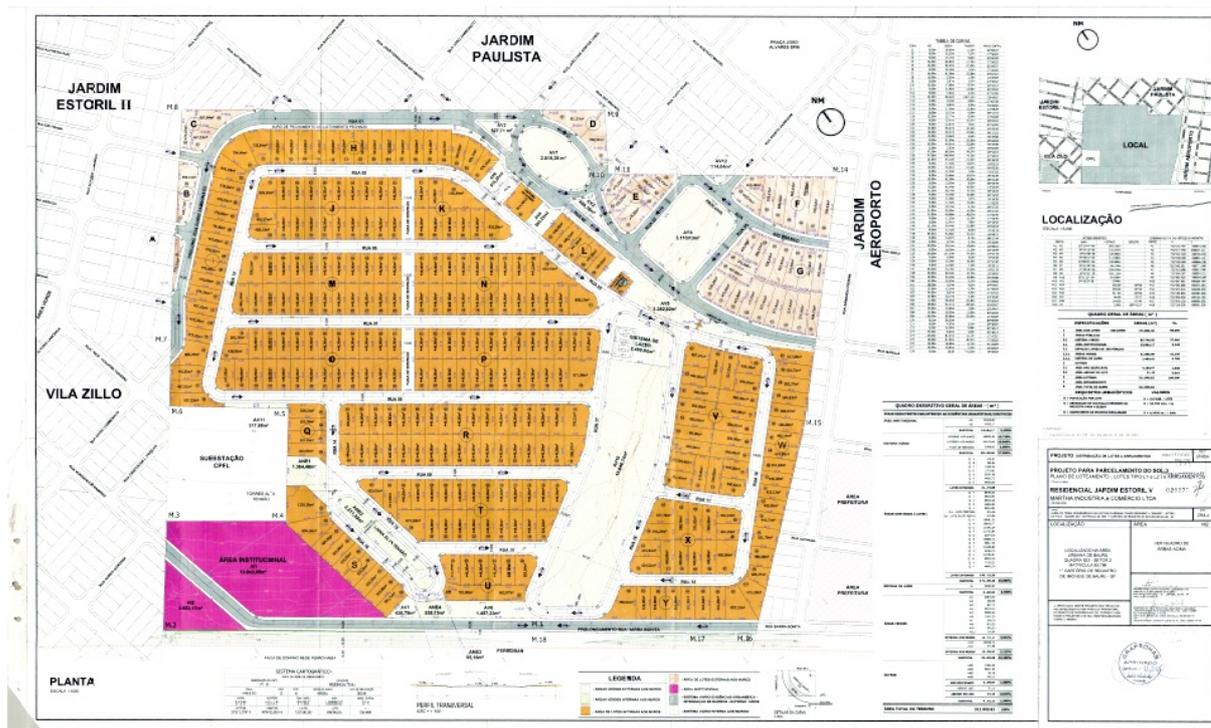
Planta de loteamento Residencial Jardim Estoril 5, aprovada em 2006.
